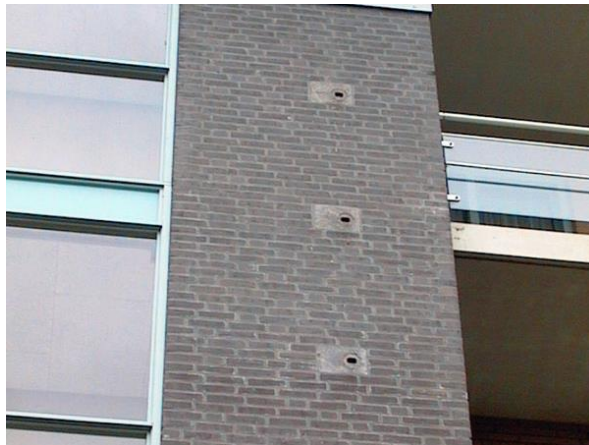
Nist- und Einbaustein Typ 25/25A, Einbaubeispiel Fassade (Quelle: www.schwegler-natur.de)
